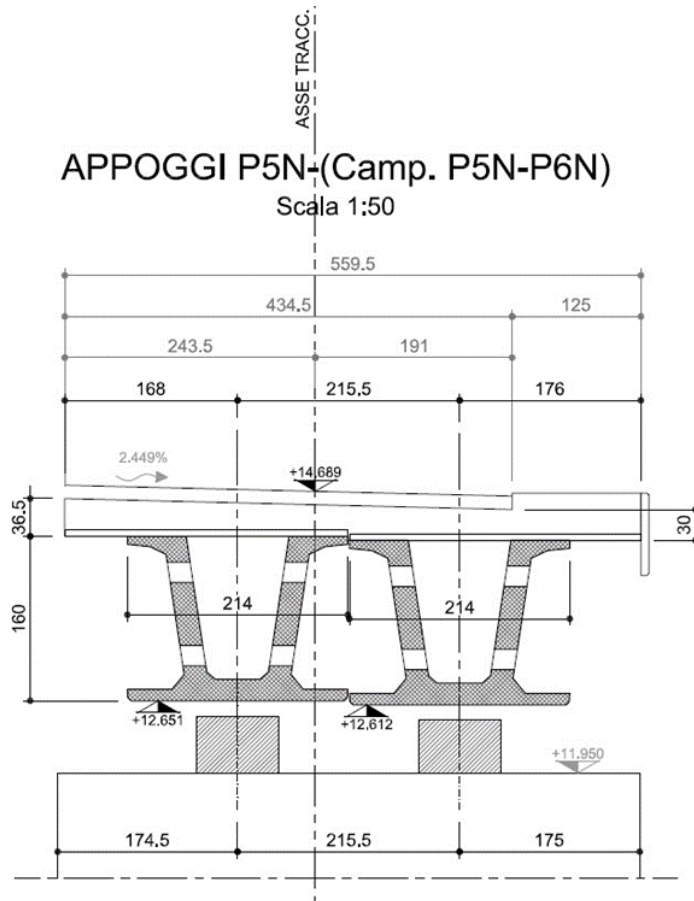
Sezione trasversale Campata 6 (a 2 travi) – Rampa N – P5_N
